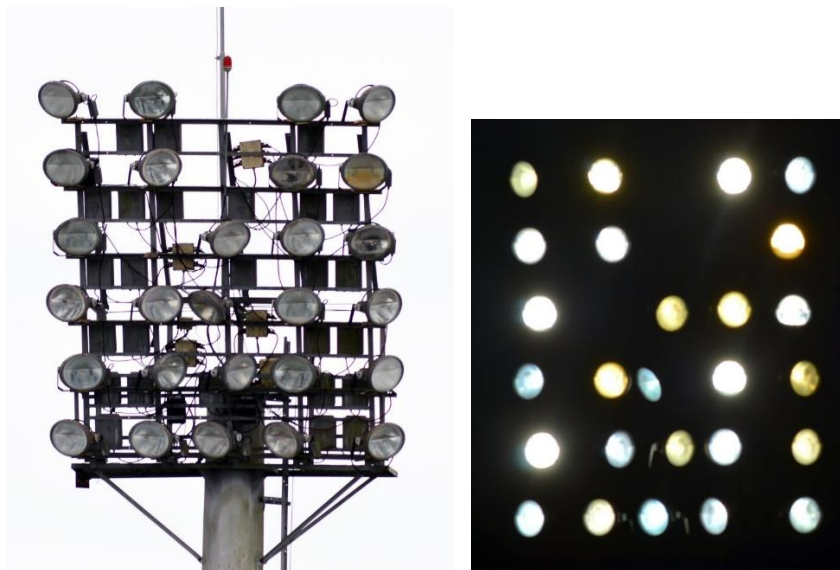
Gaiolas com 27 Projetores da Torre T1 - 01/12/2020
